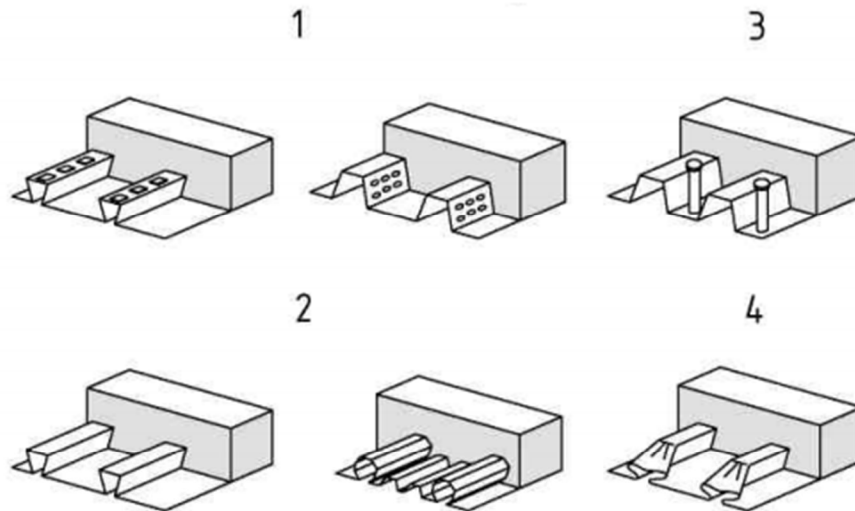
Конструкция перекрытия по профнастилу
